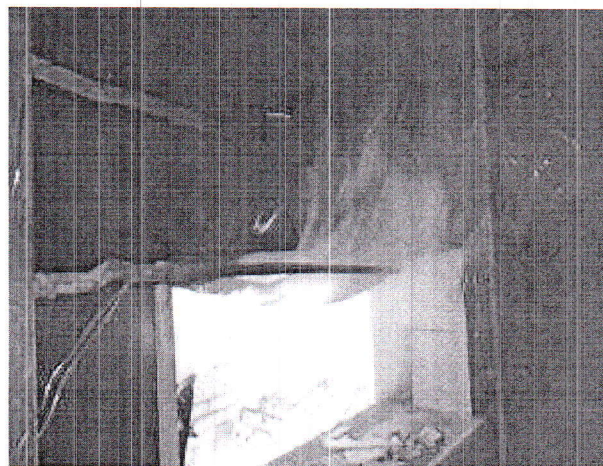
Б. Фрагмент образца фасада при испытании по ГОСТ 31251-2008.
